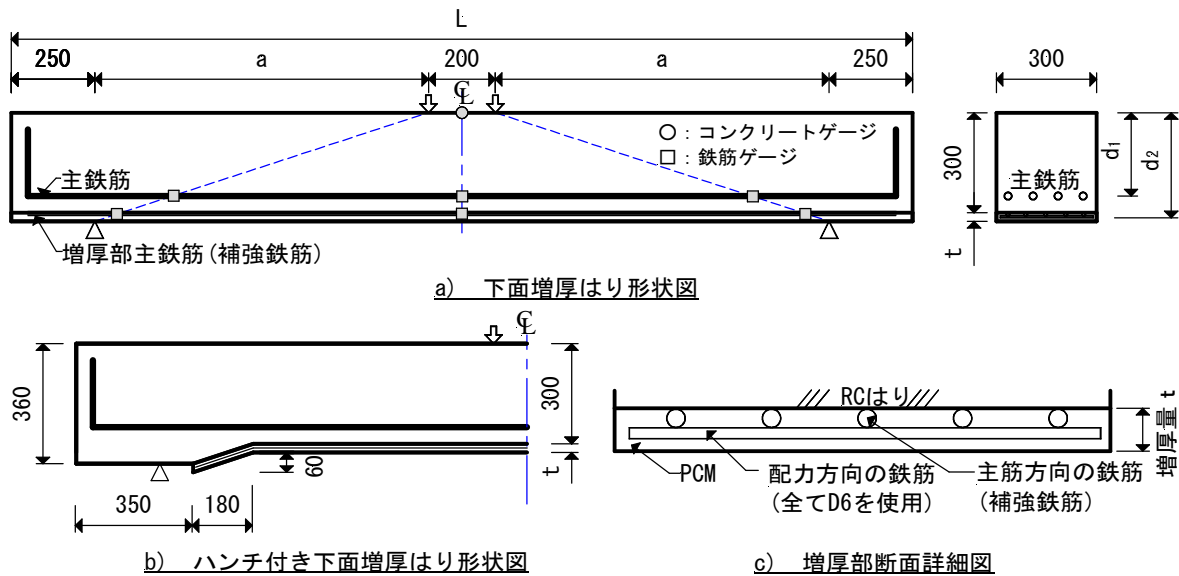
RCはり供試体の形状寸法、配筋と荷重状況
